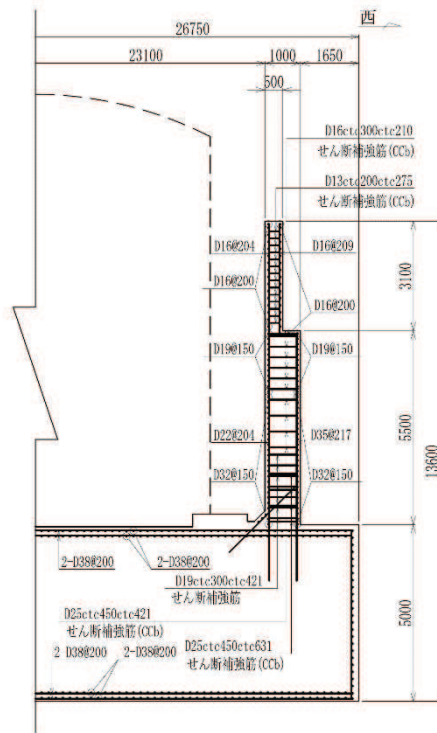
(3) 復水貯蔵タンク基礎 概略配筋図 (2-2 断面)
